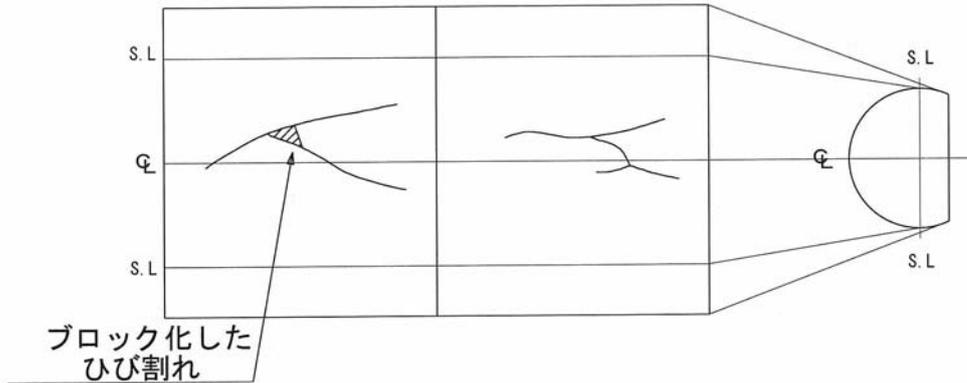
複数のひび割れでブロック化した覆工コンクリート
